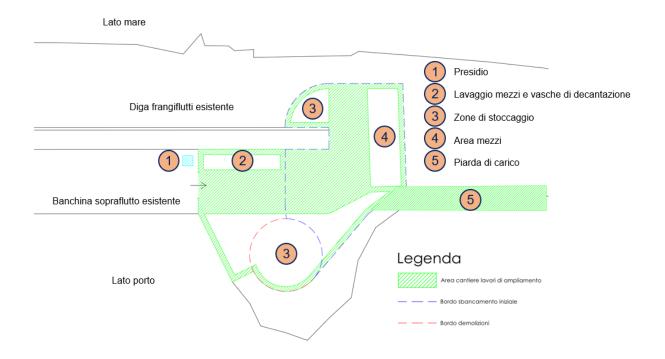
Schema area di cantiere ipotizzata all'estremità dell'attuale diga di sopraflutto.
